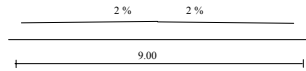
Potongan Melintang Eksisting Jl Pucang Gading Raya Sta 1+268
